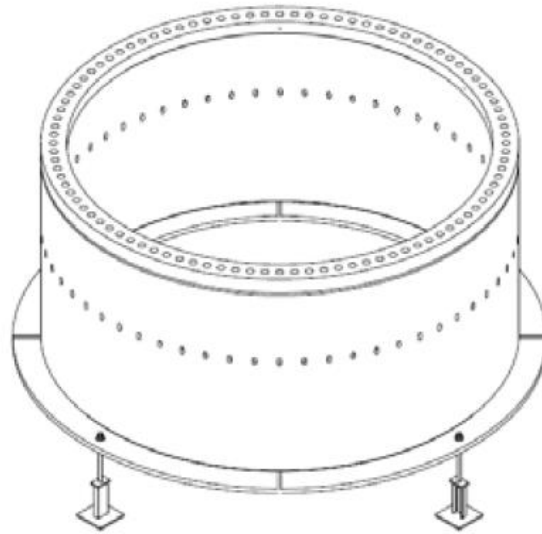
Vista da ligação em anel de aço em perfil. Fonte: [40]
